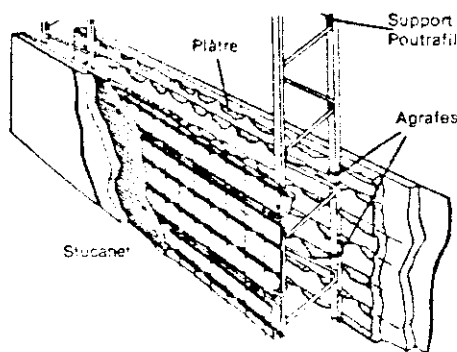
BASE DO SISTEMA CONSTRUTIVO STUCANET.
